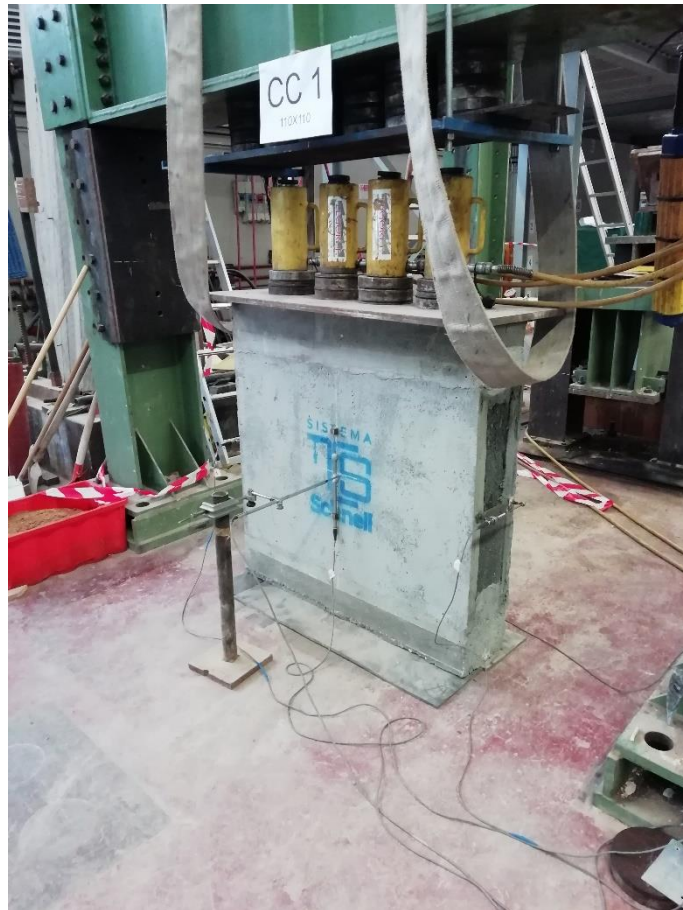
Disposizione dei trasduttori sulle facce fronte e retro, lato A e lato B del provino
